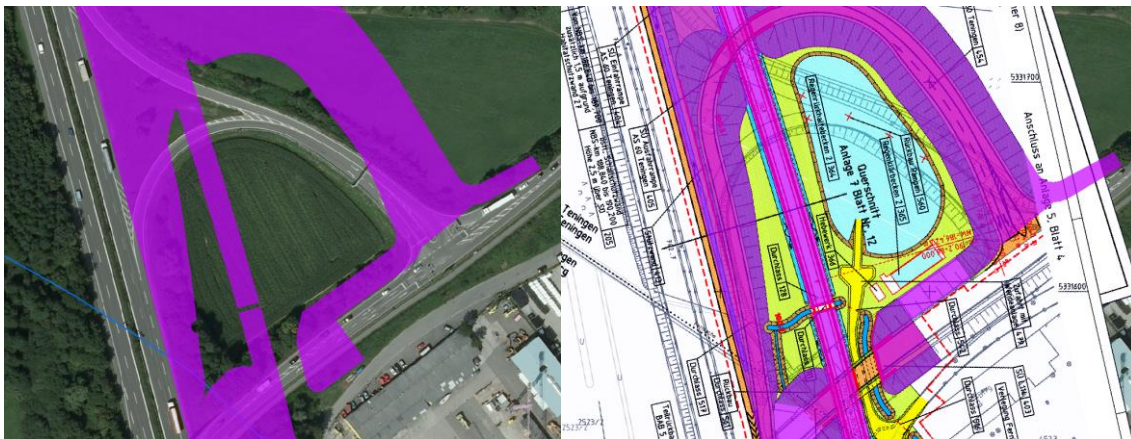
Rückbau der Rampe (Nr. 560) im Planzustand
